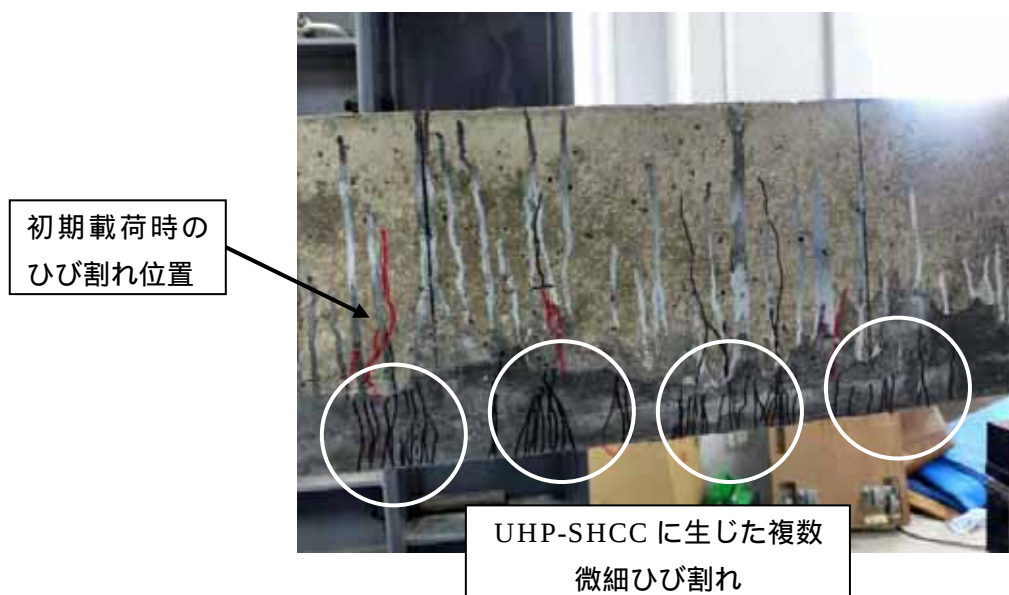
2 次載荷時のひび割れ性状の例
